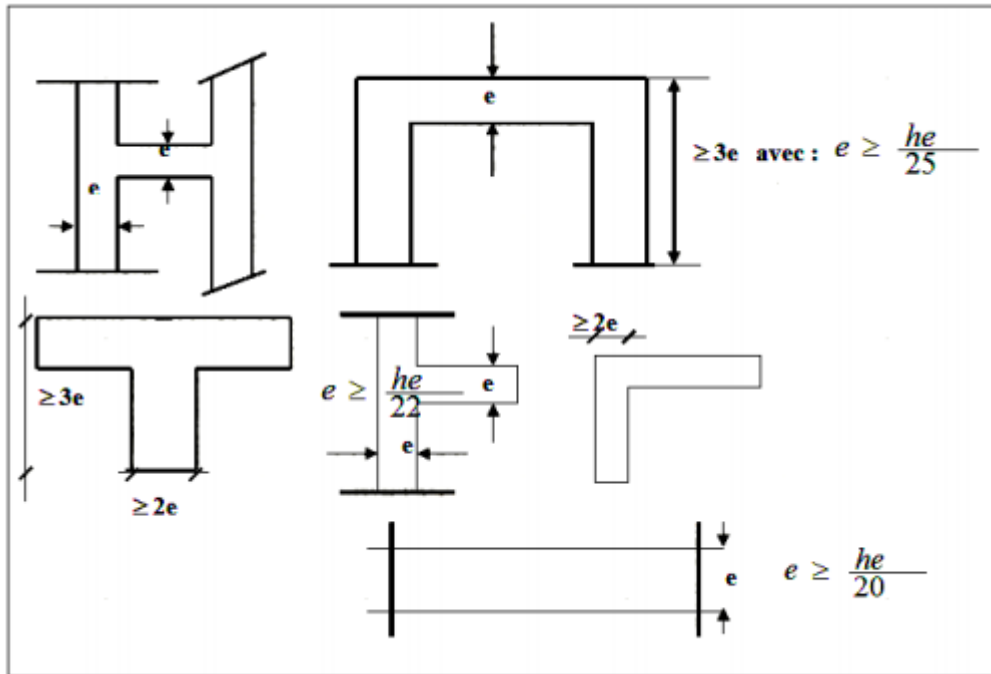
Coupes de voiles en plan (RPA 99 V 2003)
